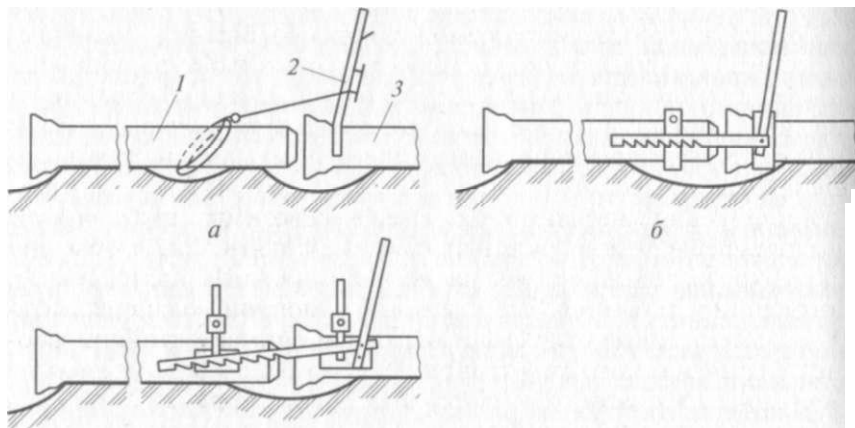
Монтажное приспособление для сборки стыковых раструбных соединений с резиновой манжетой или кольцом:
